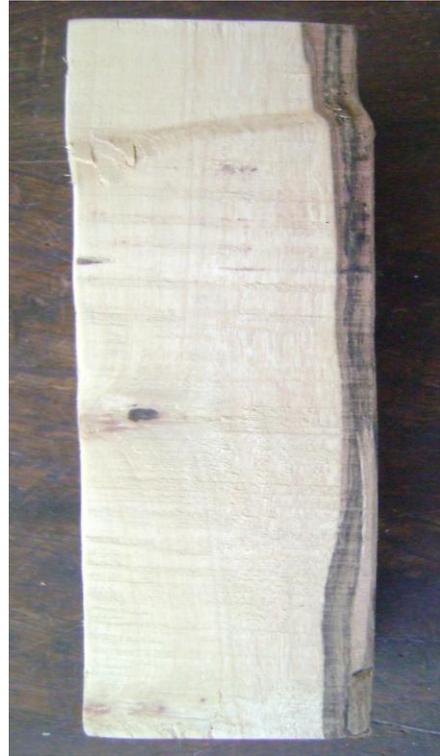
Fallas obtenidas en el ensayo, Cizallamiento y Aplastamiento
